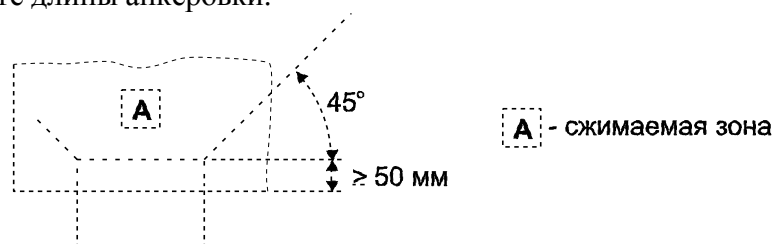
Площадь сжатой зоны, увеличивающая анкерующую способность
